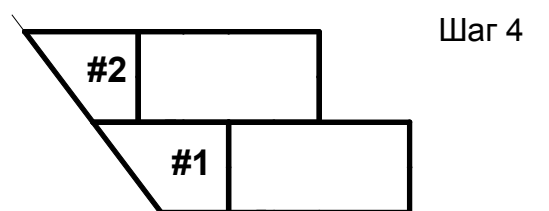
Раскрой и расположение теплоизоляционных плит в непрямым углах кровли.
